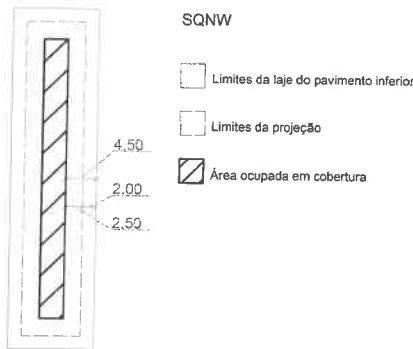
Planta esquemática da ocupação de cobertura nas superquadras do Setor Noroeste (SQNW)
